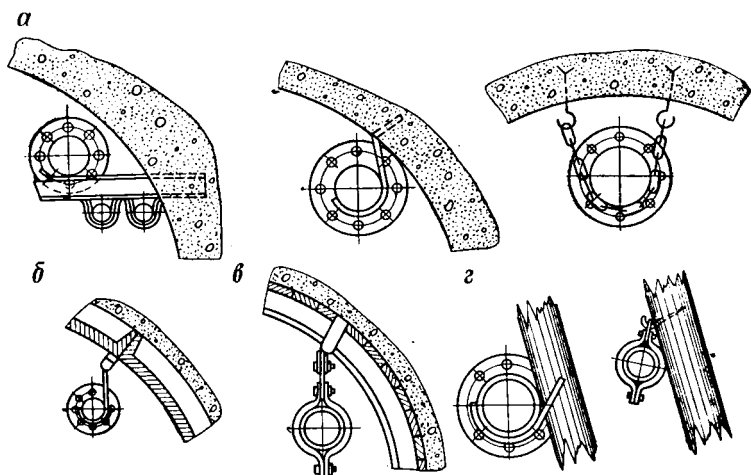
Конструкция крепления трубопроводов к крепи выработки:
